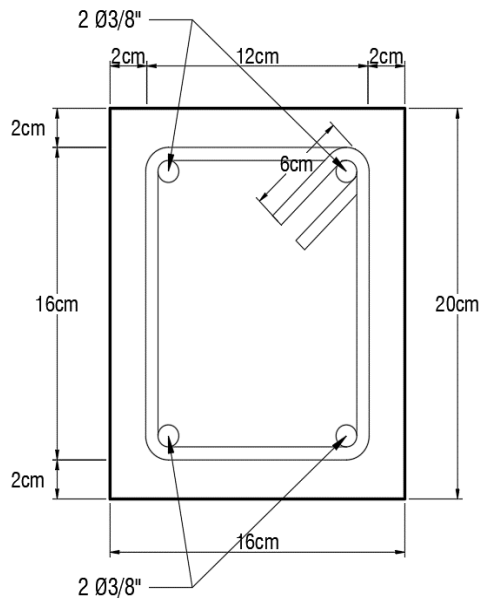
DETALLE DE SECCION DE LA VIGA DEL ESPECIMEN. Fuente: Elaboración Propia.
